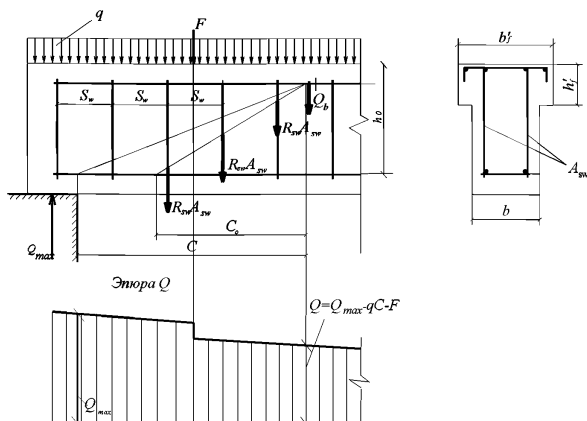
Схема усилий в наклонном сечении элементов с хомутами при расчете его на действие поперечной силы
